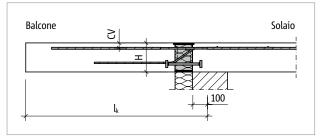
Schöck Isokorb® XT tipo KL-M1 – M10: schema statico
